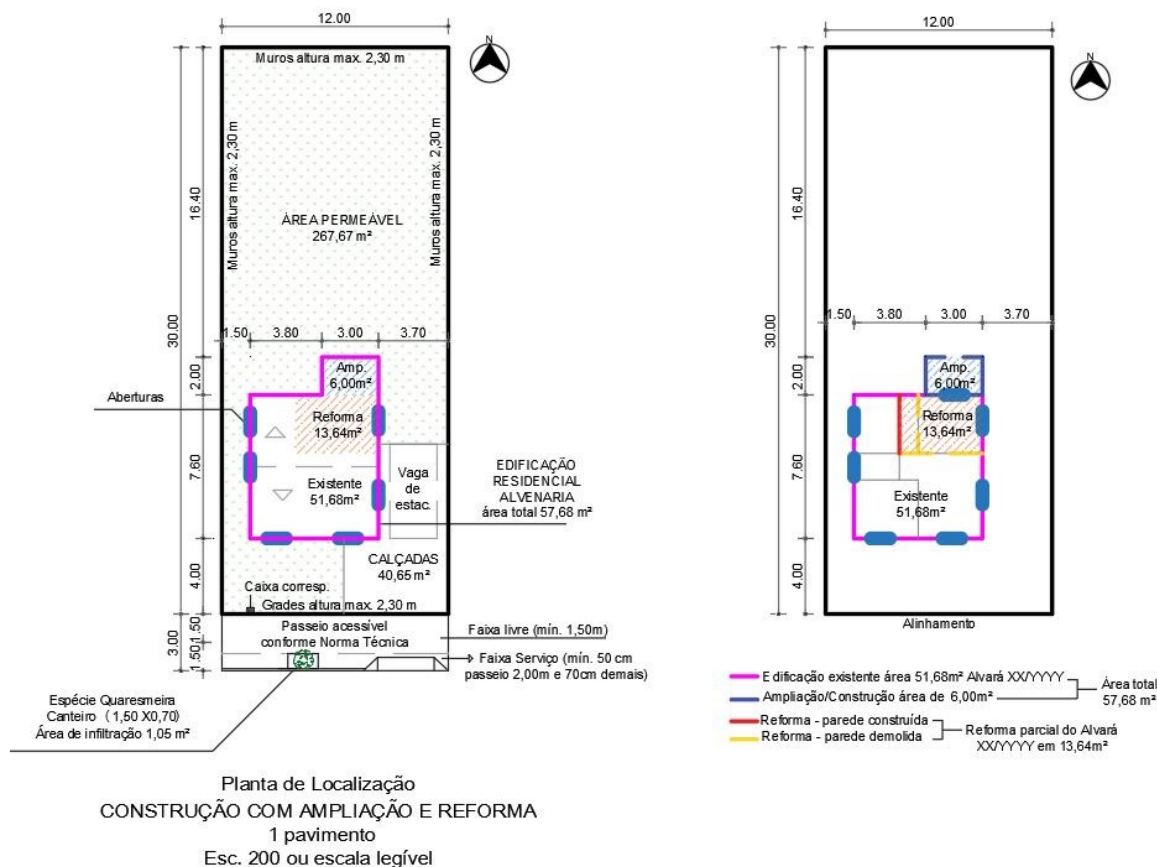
Croquis demonstrativos da planta de localização e planta de ampliação e reforma
